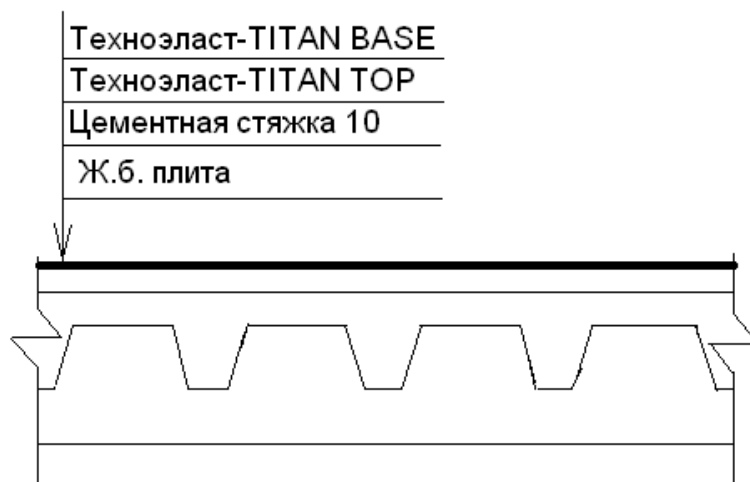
Схема сбора нагрузок на плиту покрытия
